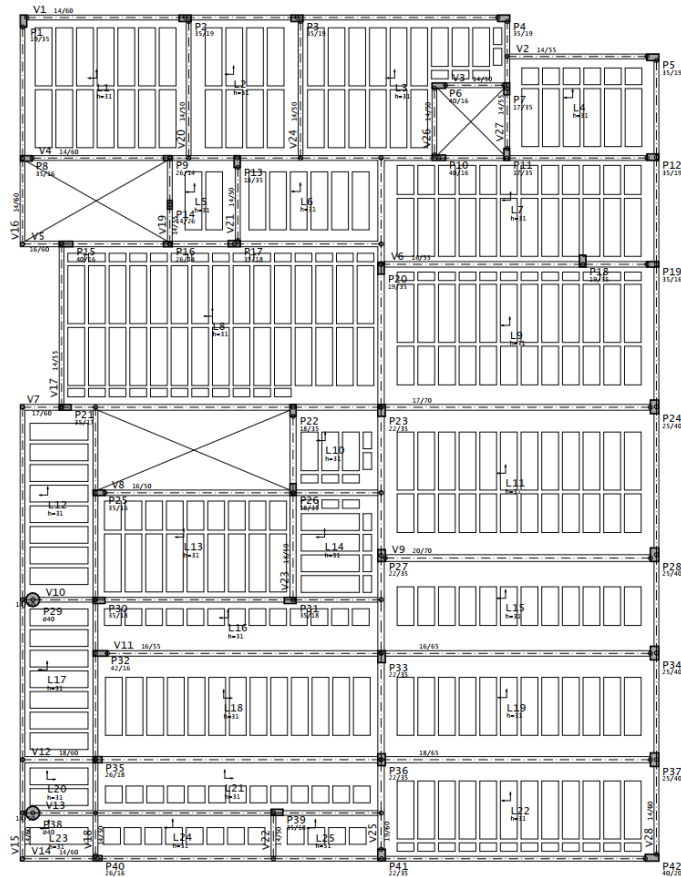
Planta de fôrma do sistema de laje nervurada unidirecional em concreto armado no TQS. (Fonte: Autoria própria; 2023)
